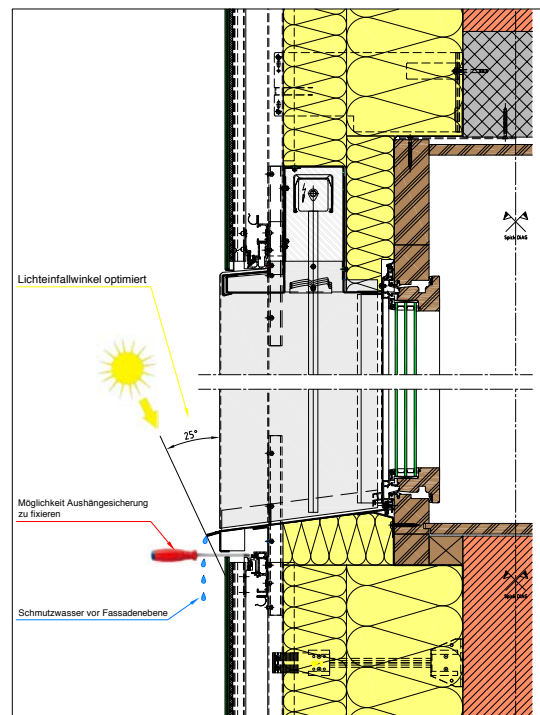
Detailschnitt Fenster aktive Glasfassade
